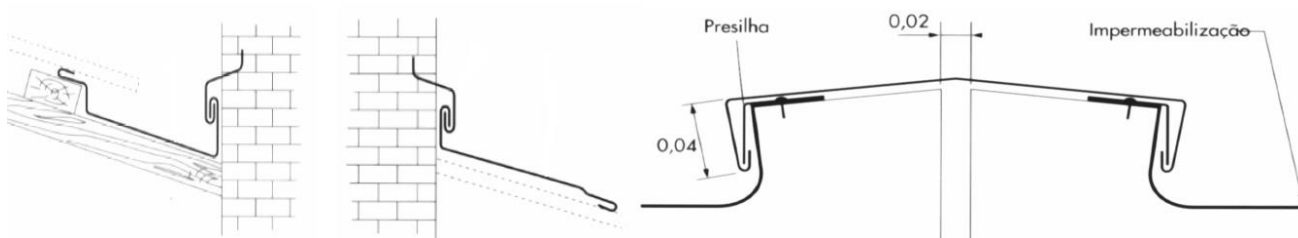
Pormenores construtivos de pontos singulares de telhados de zinco (Vi, n.d.)
